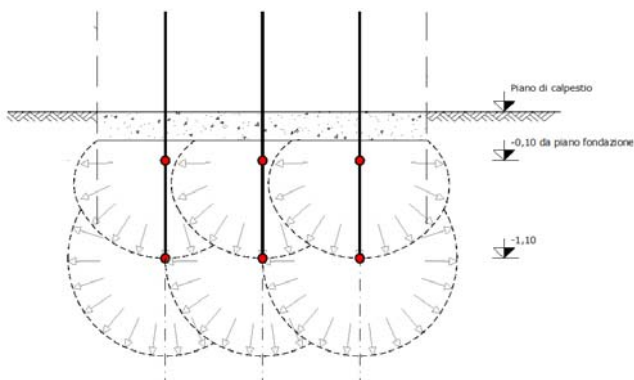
Exemple de maillage d'injection sur deux niveaux, sous une dalle béton
